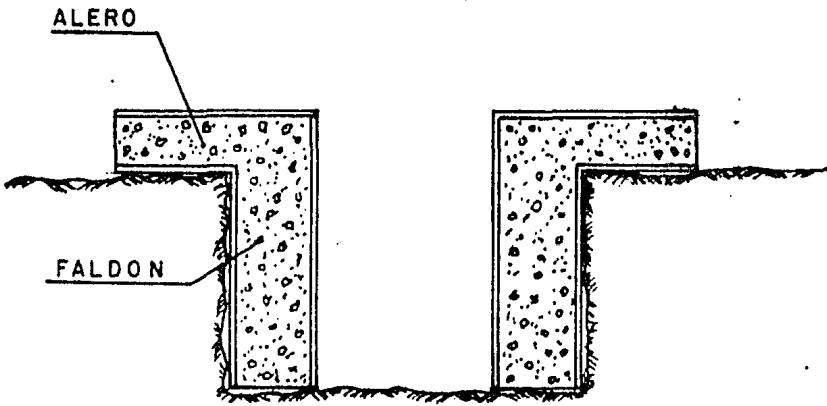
FIGURA I. EXCAVACION, ARMADO Y CIMBRADO DE BROCALES
